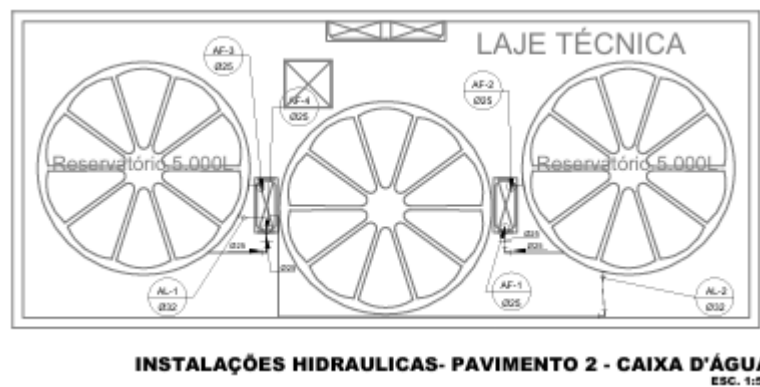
Instalações Hidráulicas do Pavimento 2 – Caixa d'água
